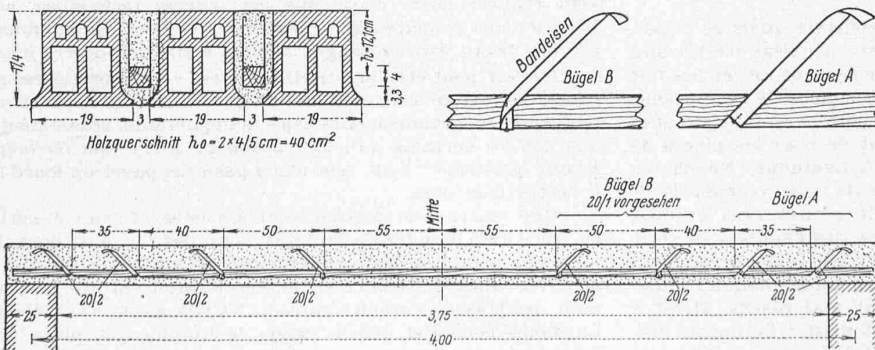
Holzbewehrte Versuchs-Betonbalken von Ing. E. Sperle, Ulm. Erste Ausführung
